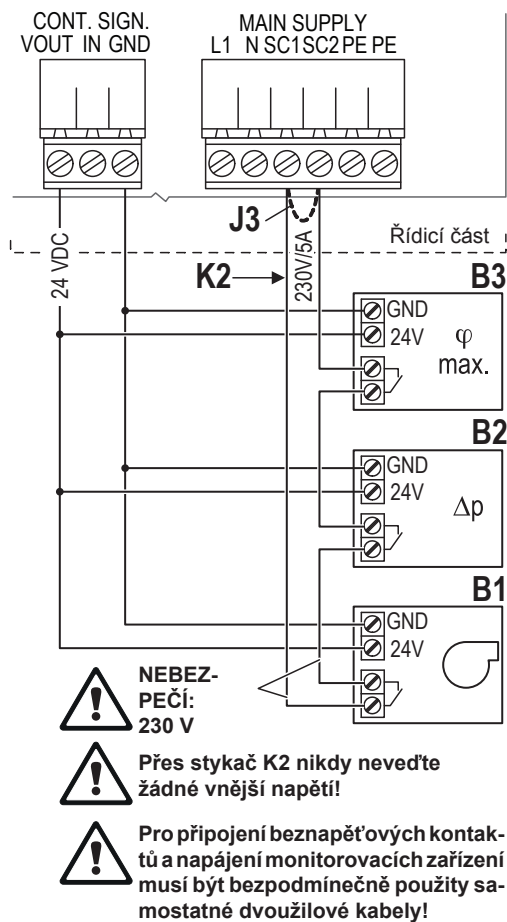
Schéma elektrického zapojení dvojčtých (2 × "M") jednotek Condair EL 35–90
